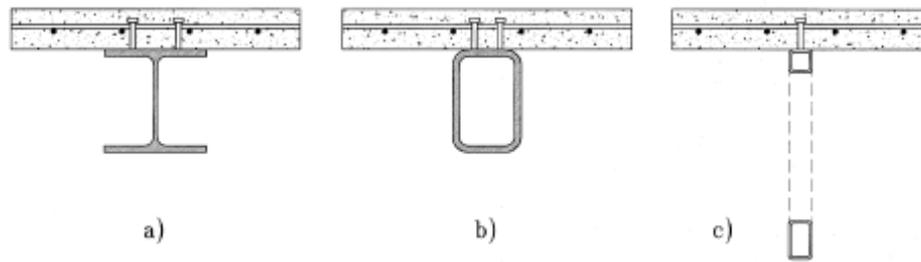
Vigas mistas (a) Seção de aço em I. (b) Seção de aço em caixão. (c) Sistema treliçado.
